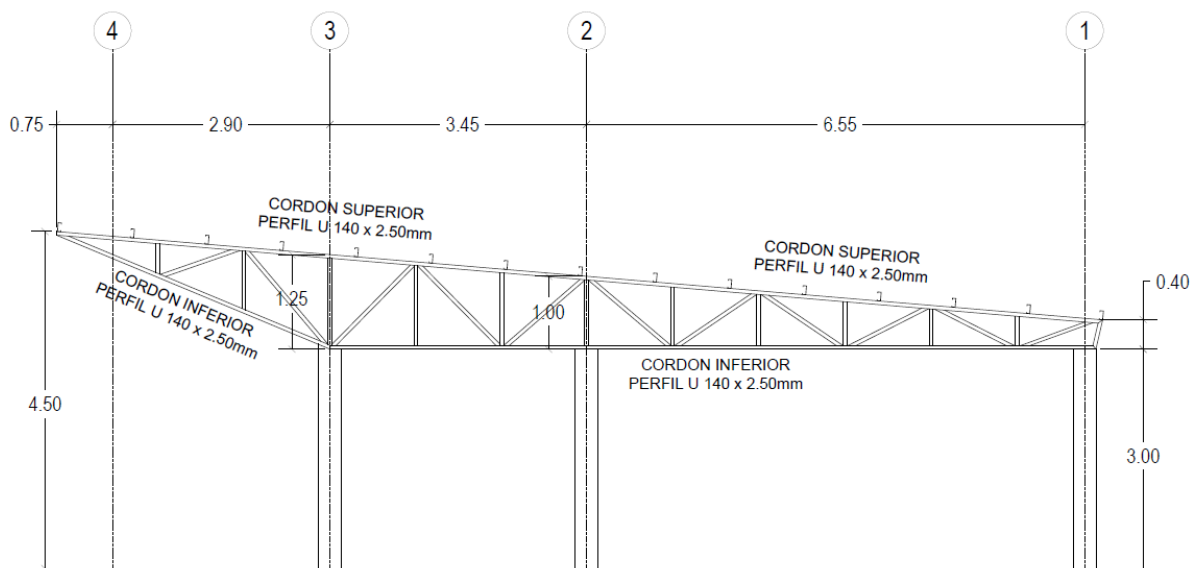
DETALLE DE VIGA RETICULADA | CORDON SUPERIOR E INFERIOR
